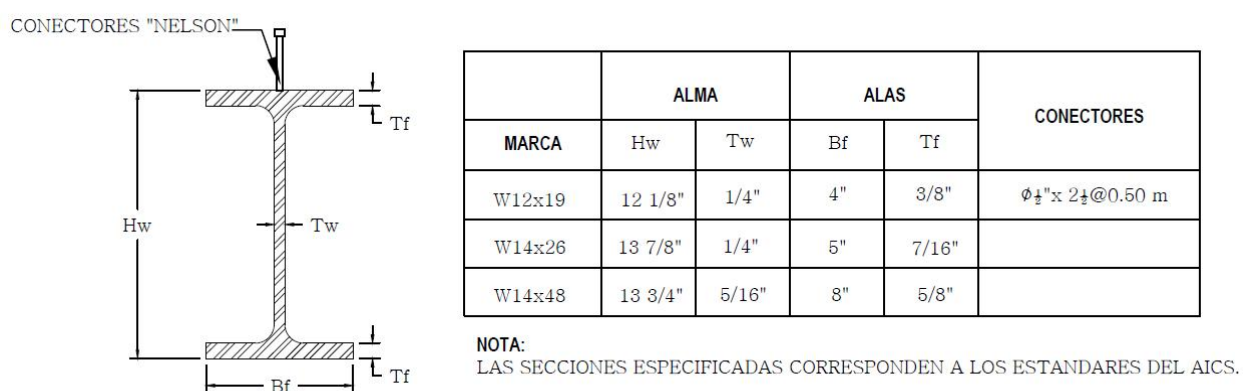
Detalles perfiles estructura metálica Edificio Anexo y Madame Curie Banco Ademi
